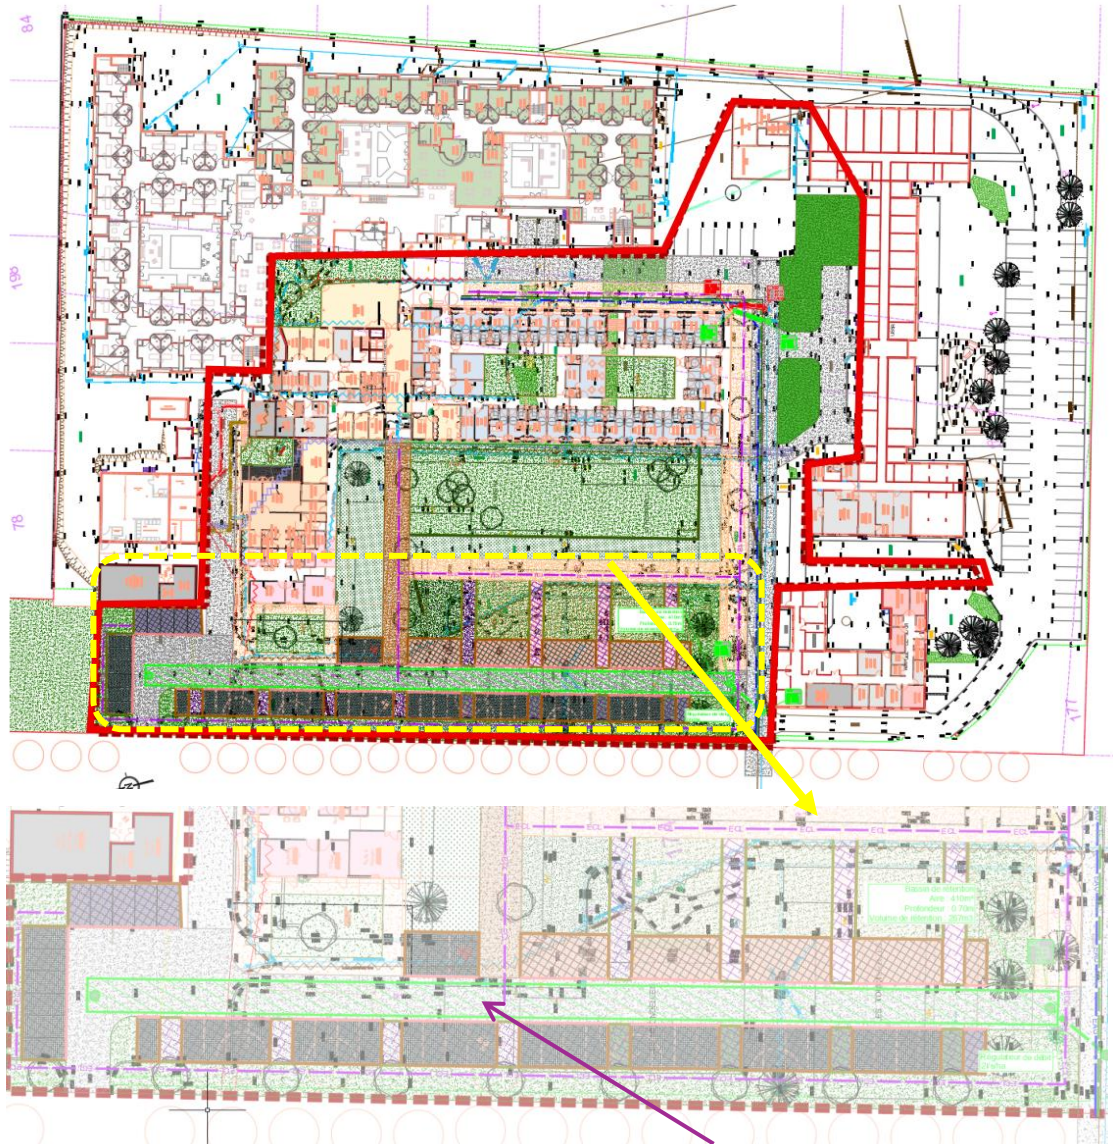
Extrait plan VRD avec repérage bassin de rétention
